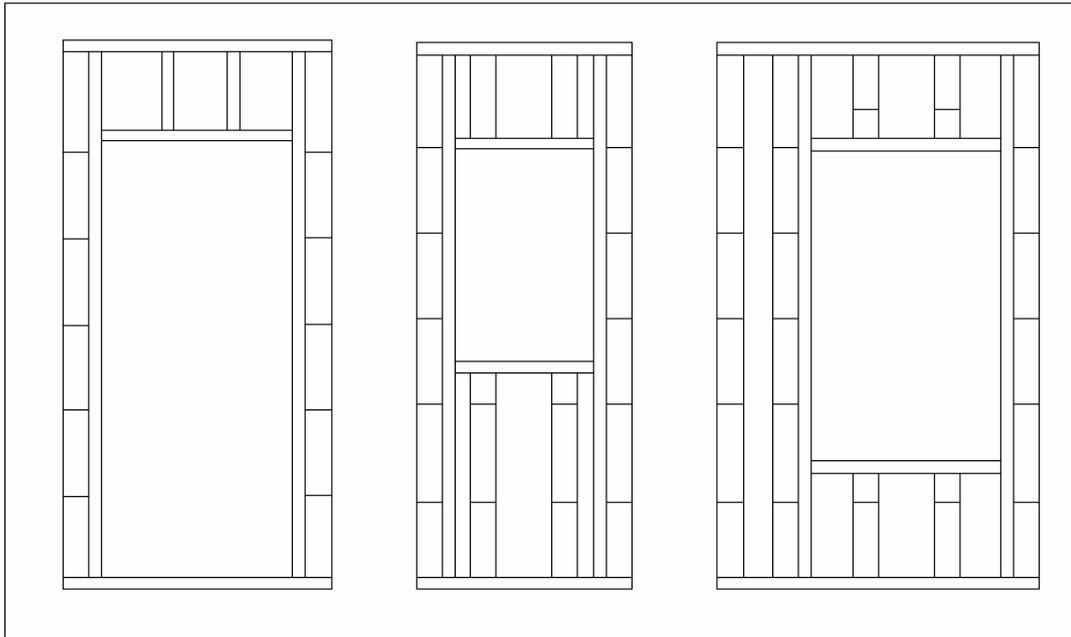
Paneles de caña y madera para ventanas y puerta
